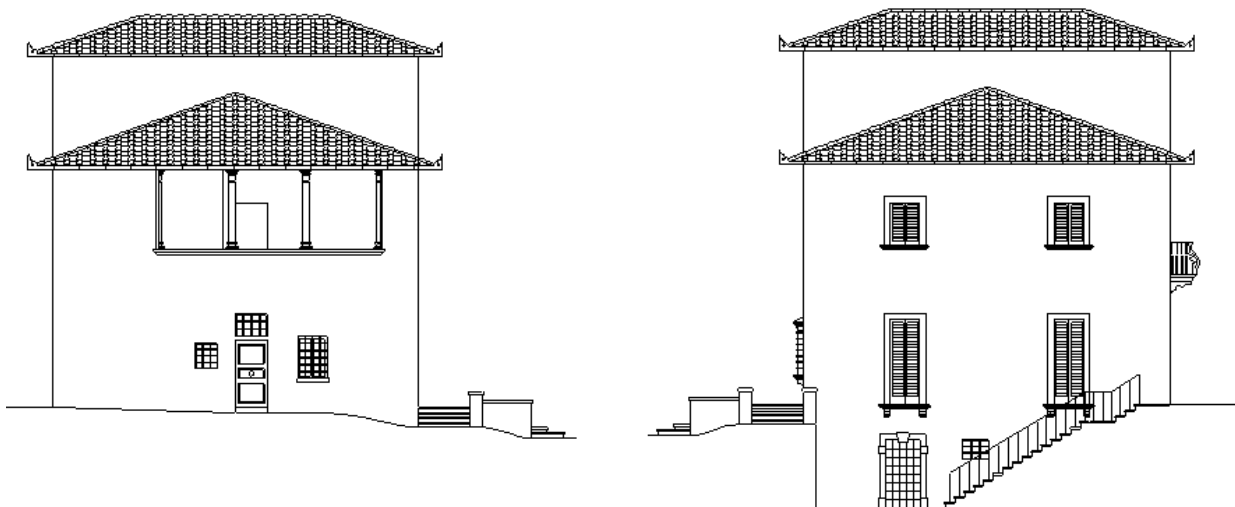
Prospetto Ovest (a sinistra) e Est (a destra)
